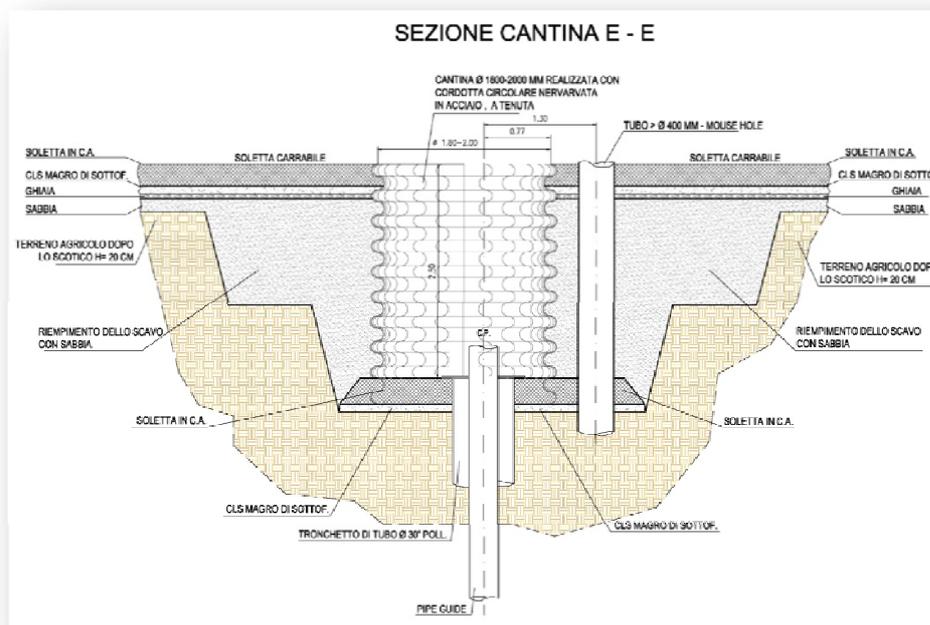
Sezione dell'area interessata dalla cantina di perforazione
